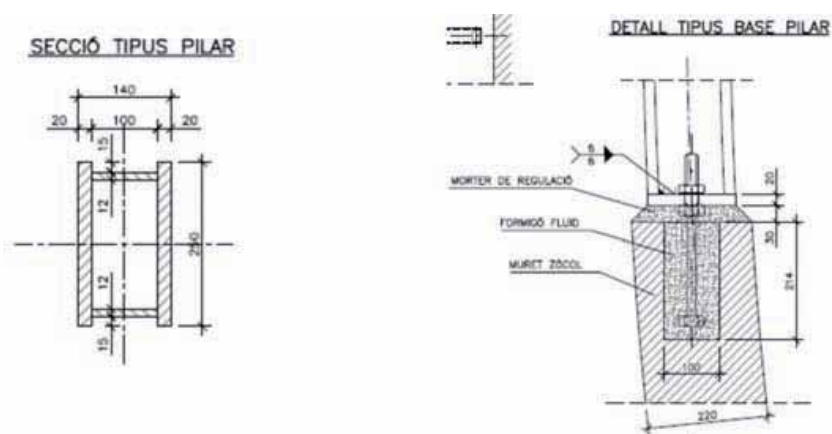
Sección y detalle de los pilares del forjado mixto ligero.
